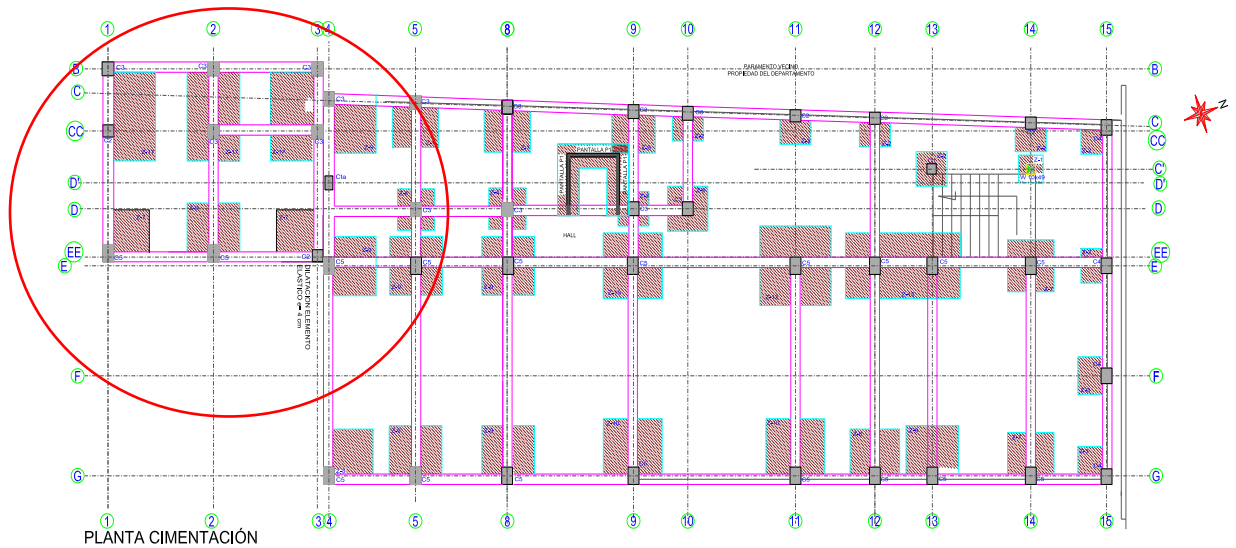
PLANTA DE CIMENTACION BLOQUES 1 Y 2
